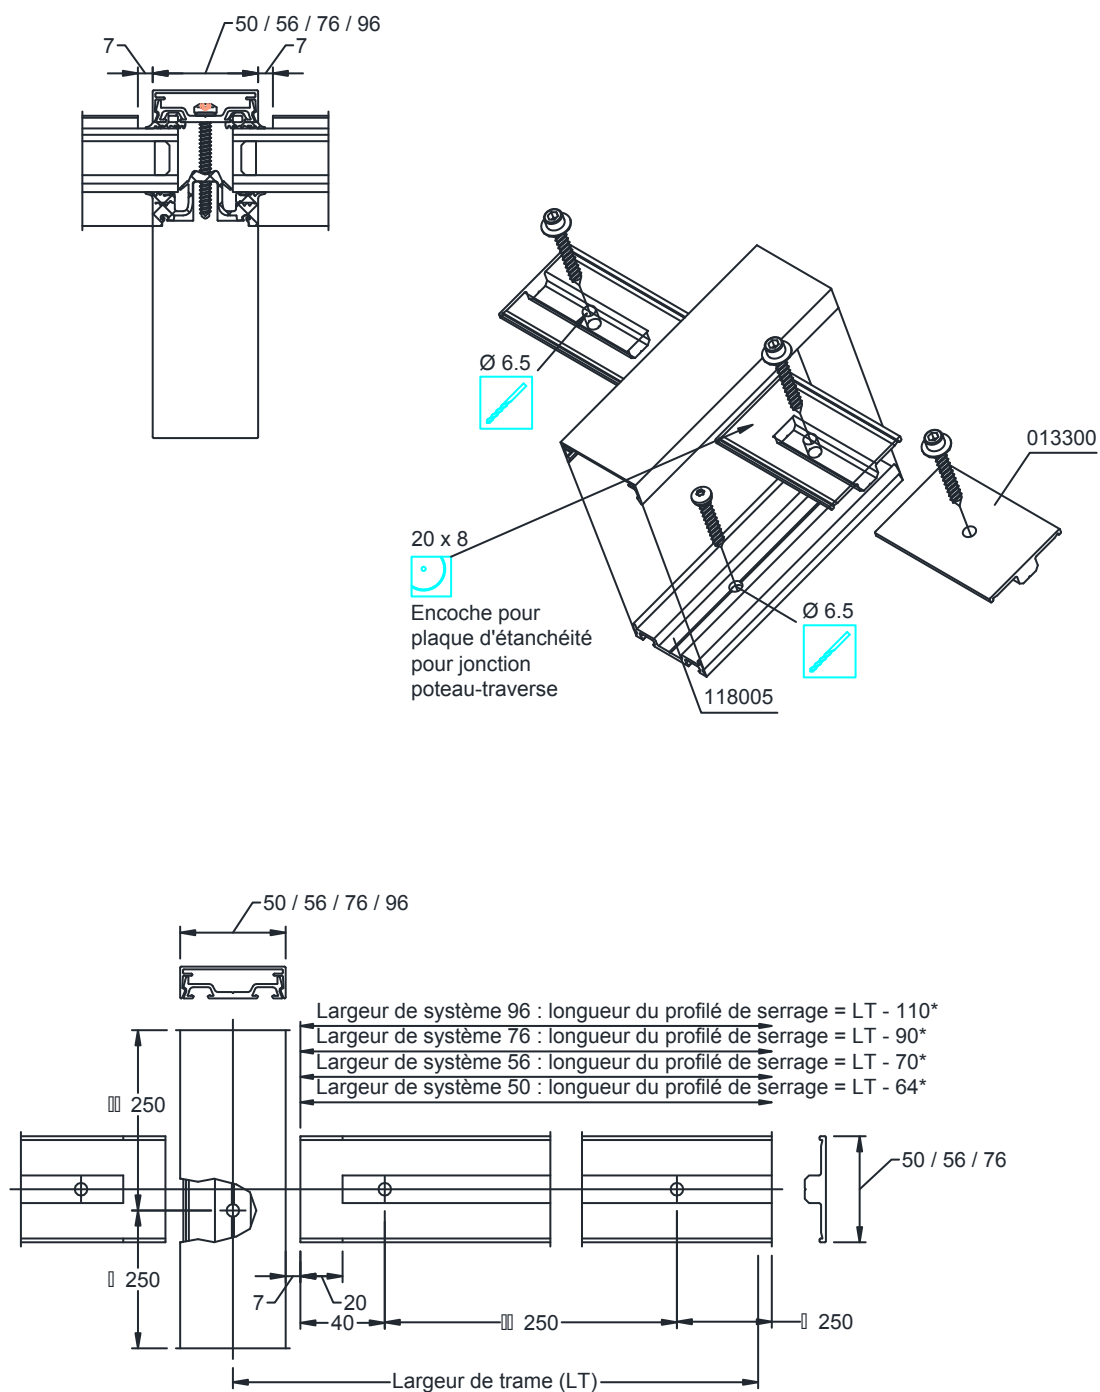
Découpe et usinage des profilés de serrage : serreur plat de 3 mm
